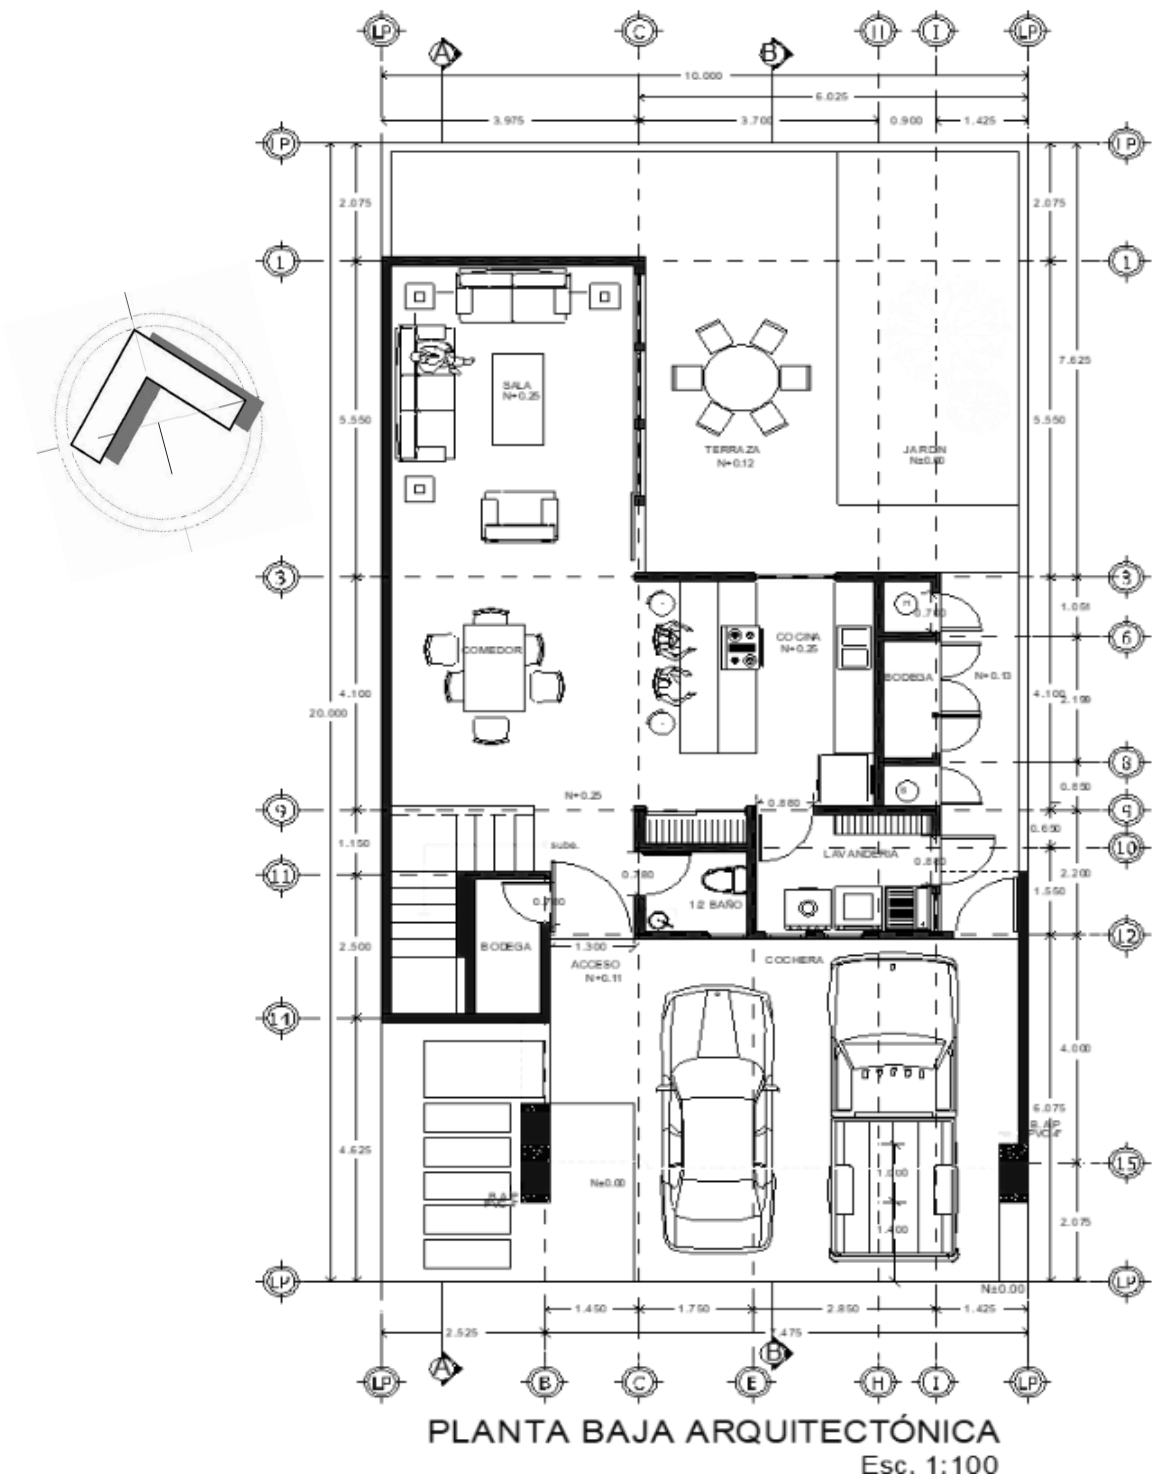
Planta arquitectónica vivienda unifamiliar prototipo Santa Bárbara (Planta Baja).
